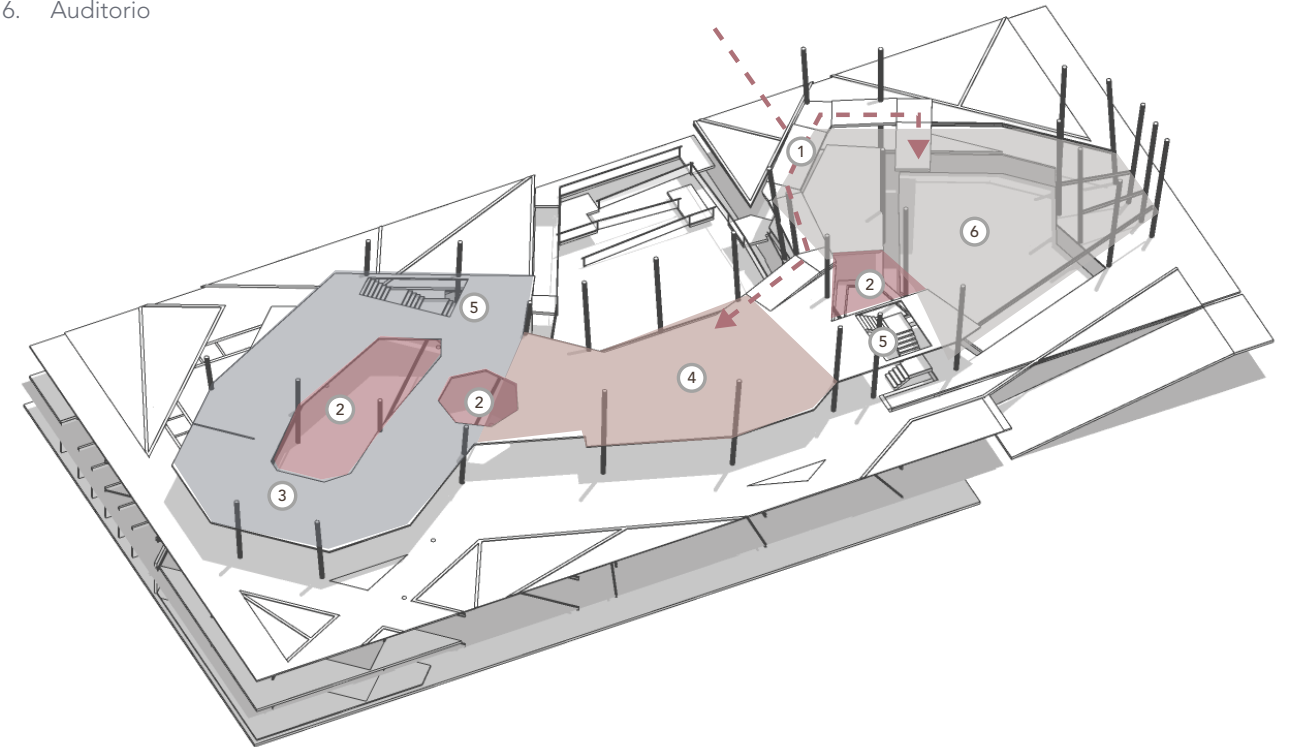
Elementos Constructivos y Espacialidad Primer Piso
